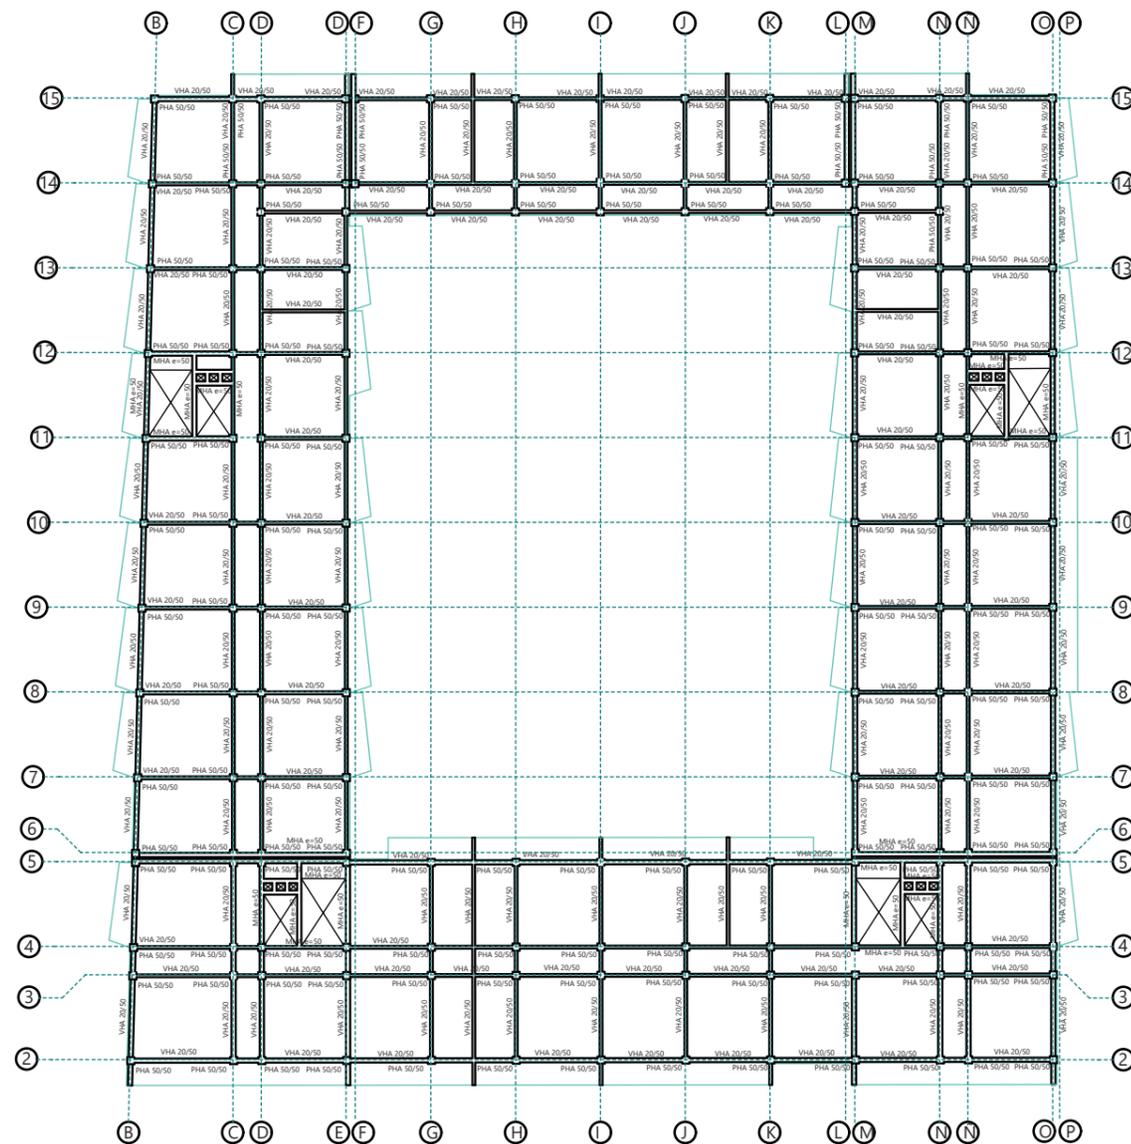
Estructura planta tipo. Planimetría en proceso. Elaboración propia.
